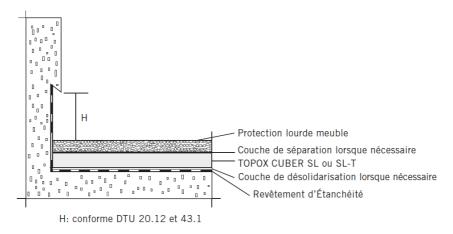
Relevé sur toiture-terrasse inaccessible avec retrait formant larmier
